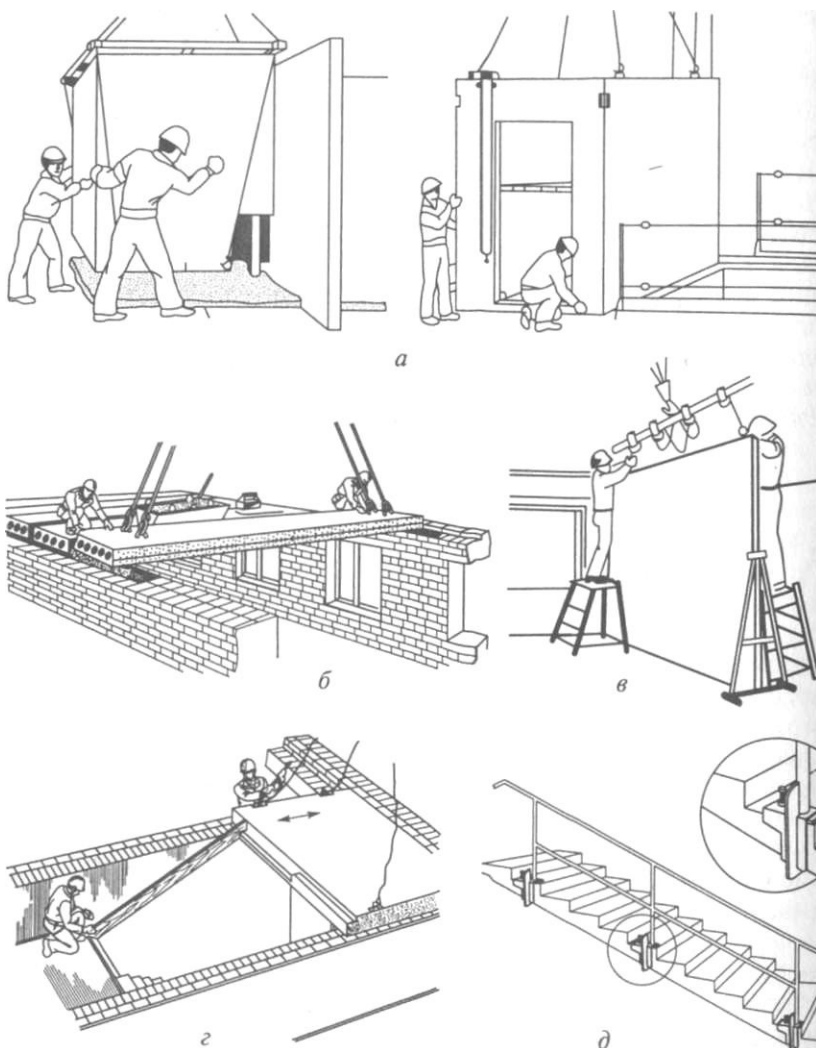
Установка сборных железобетонных элементов: а — объемных сантехкабин и лифтовых шахт; б — плит перекрытия; в — перегородок; г, д — разметка мест установки и ограждения лестничных маршей
